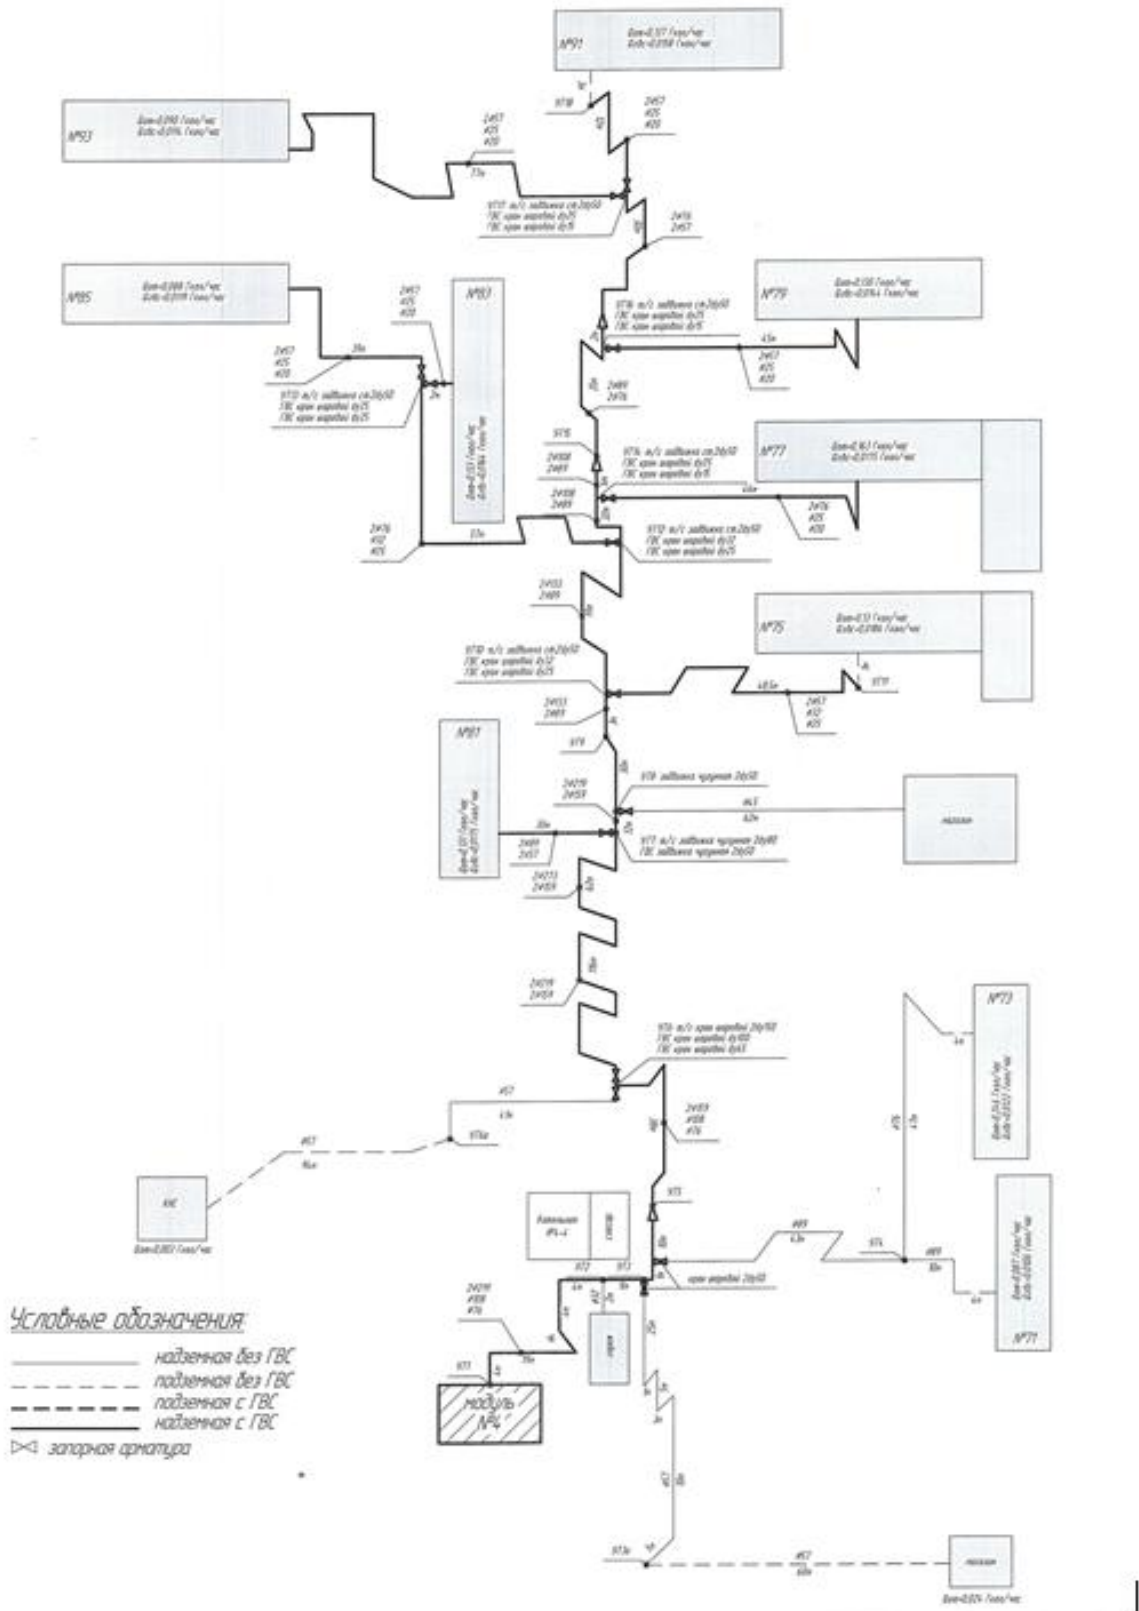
Схема тепловых сетей котельной №4-4 п. г. т. Безенчук
